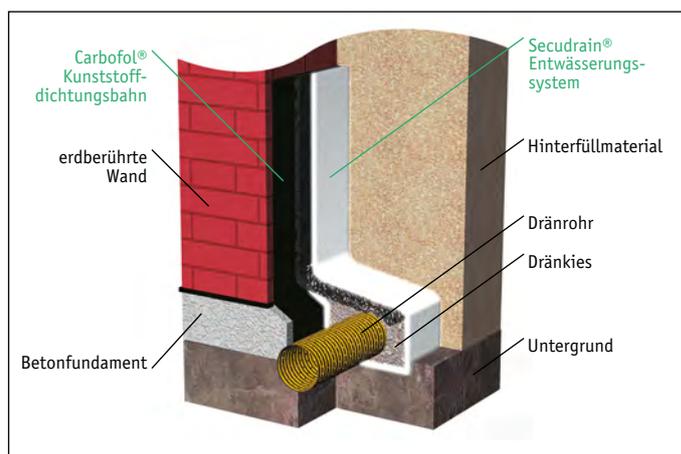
Bauwerkentwässerung (Detail Dränanschluss)
